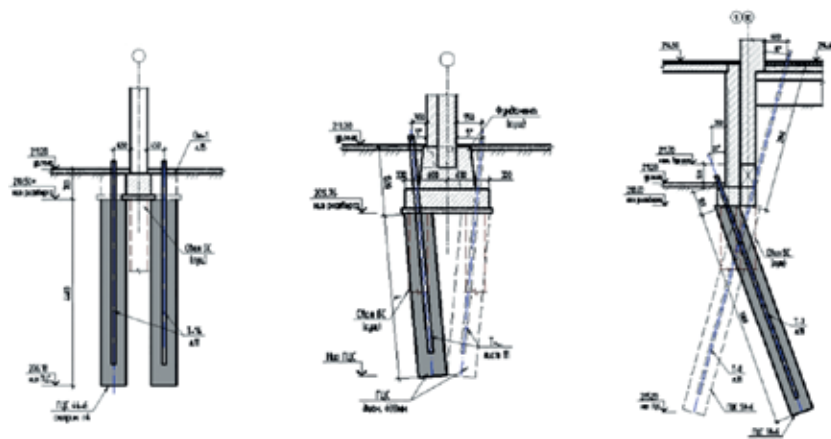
Конструкция усиления существующих фундаментов грунтобетонными элементами
